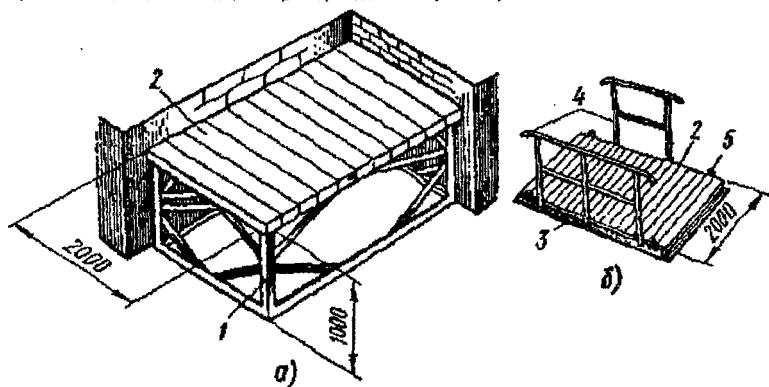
Переносные площадки-подмости для кладки наружных стен лоджий и перегородок (а) и наружных стен лестничных клеток (б):
